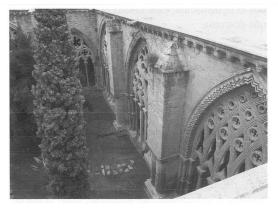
Imagen, en segundo plano del contrafuerte 2–3 objeto del presente estudio. En primer plano el contrafuerte 3–4 con doble apilastramiento
